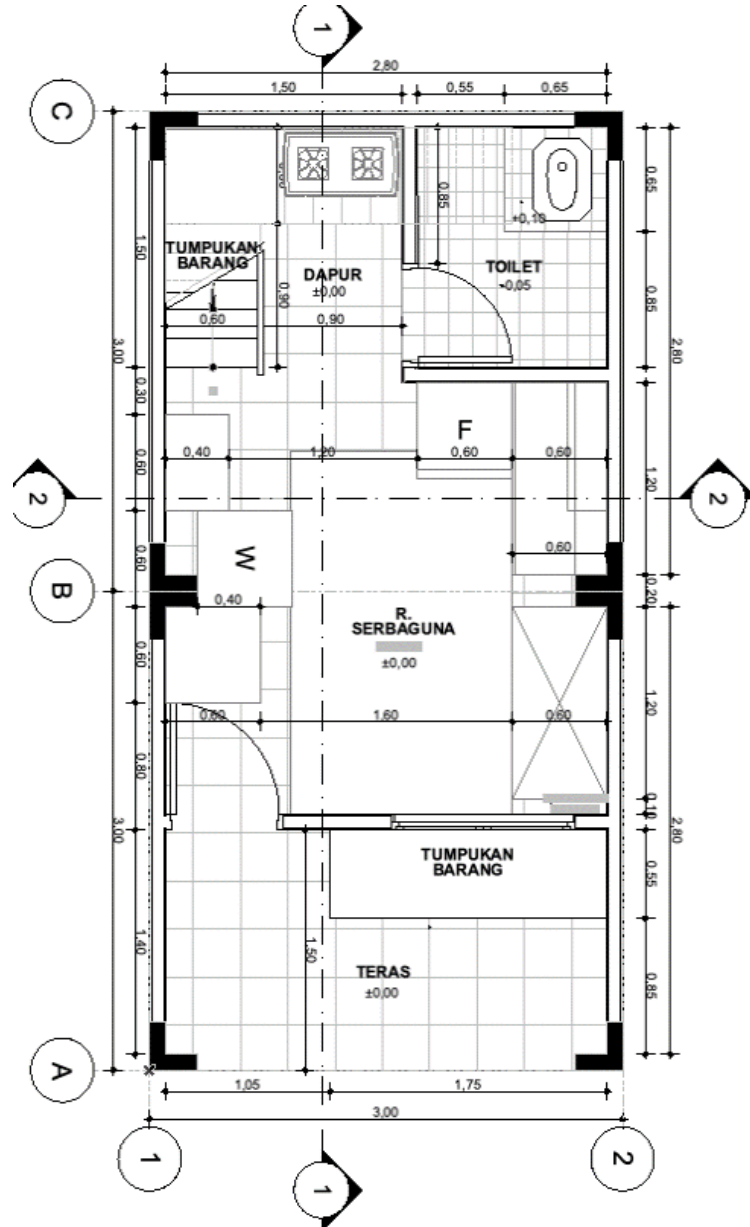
Layout Denah Lantai Satu Tipe 18
